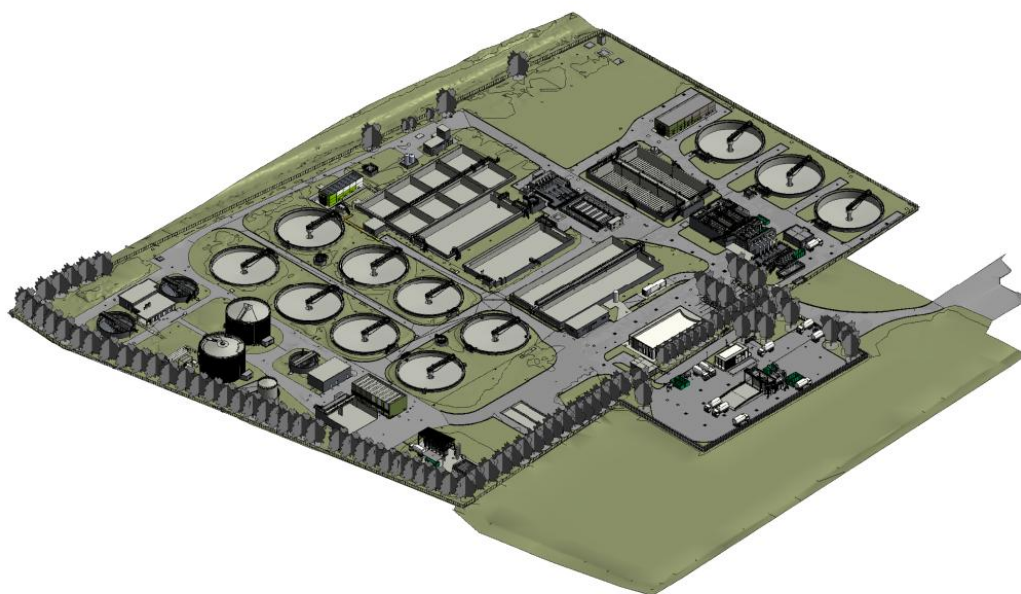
Modello tridimensionale stato di progetto impianto di depurazione di Ravenna
